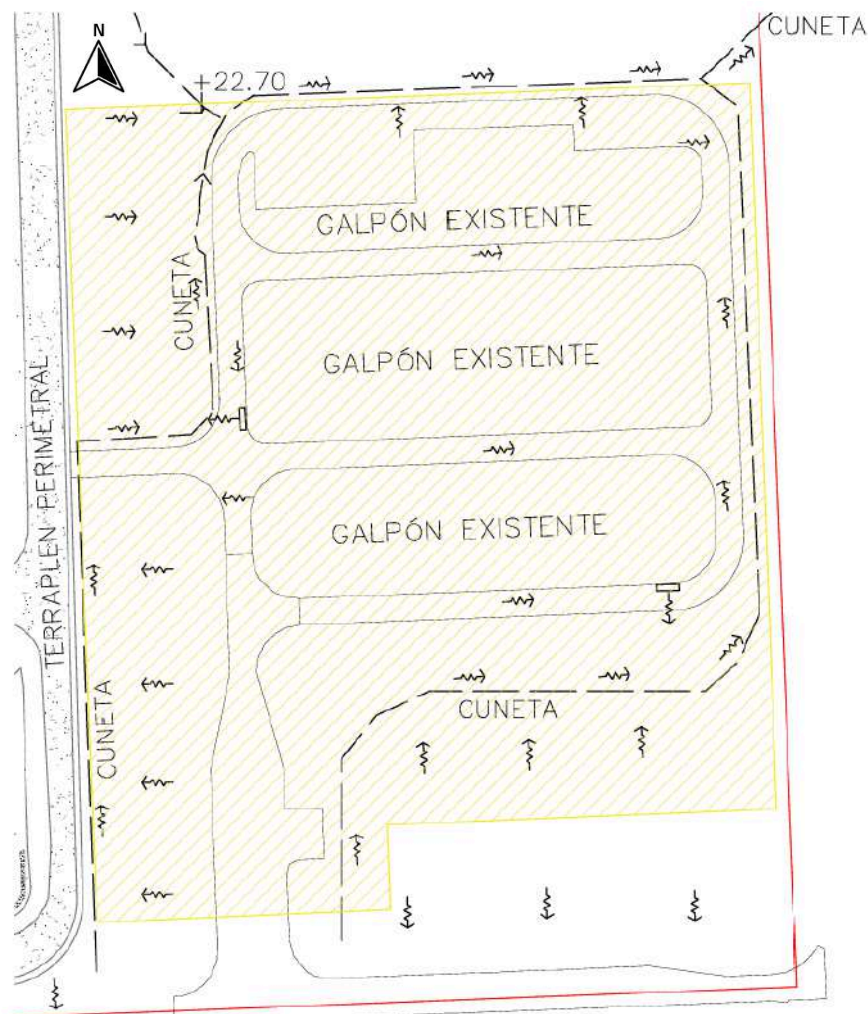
Cuenca de aporte de alcantarillas sobre cuneta existente. Fuente: Proyecto original Centro GIRSU de Villa Gobernador Gálvez.
